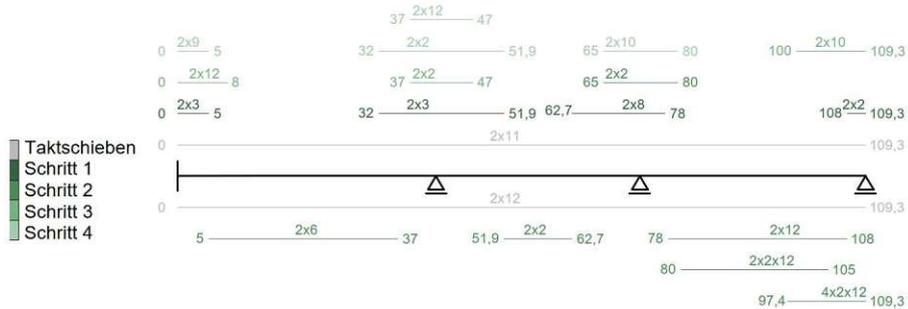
Vorspannung Betonagevariante B (Eigene Darstellung in Anlehnung an Raphaela Hackl [1])
